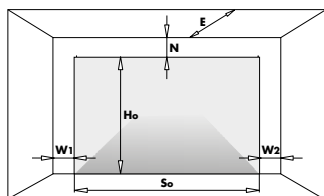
Монтажные размеры, необходимые для правильного выбора и установки подвесных откатных ворот – монтаж к притолоке.
